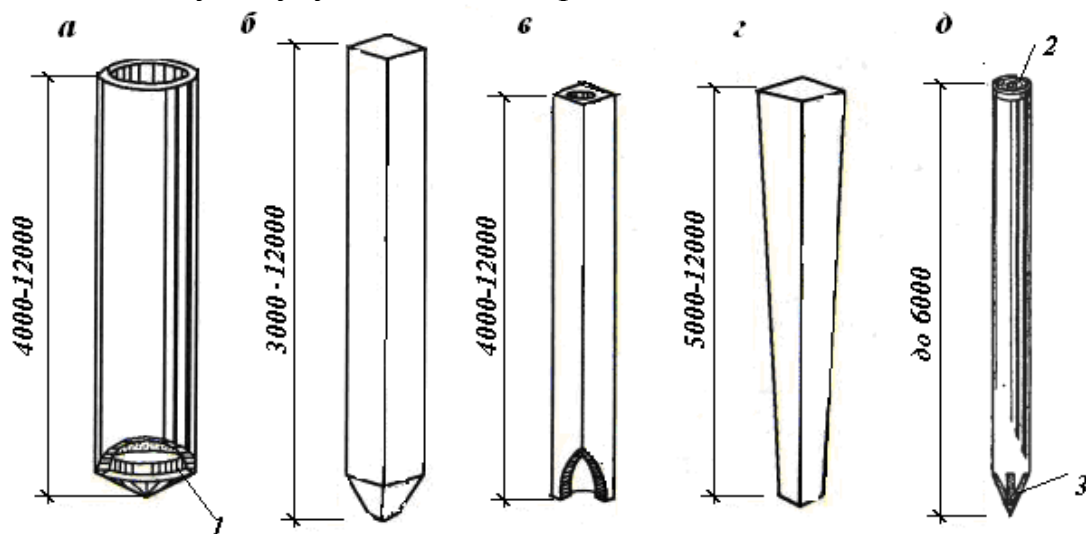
Фундамент із забивних палей: а – паля трубчаста; б – залізобетонна суцільна призматична паля; в – та ж з круглою порожниною; г – залізобетонна пірамідальна паля; д – дерев'яна паля; 1 – стальний башмак забивної палі; 2 – стальний бугель; 3 – стальний башмак
